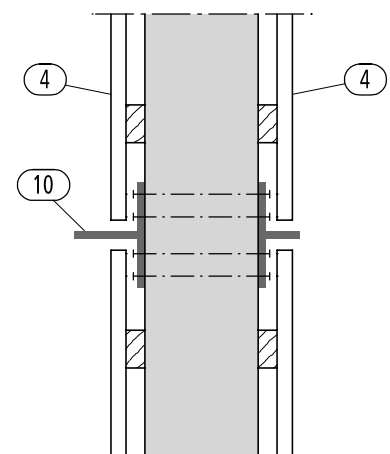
Detailschnitt: Stahlrahmen wird zur Gliederung der seitlichen Bekleidung verwendet
